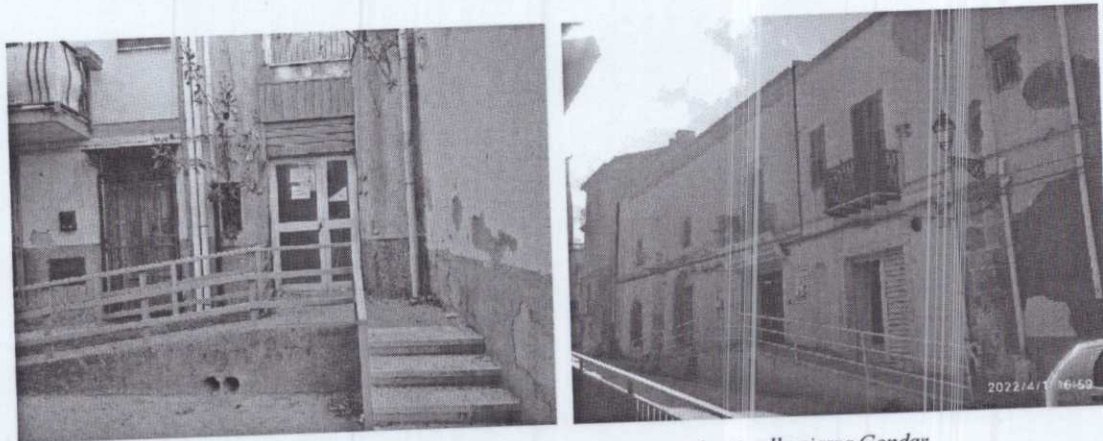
A sx il vano di accesso a dx prospetto prospiciente alla piazza Gondar
